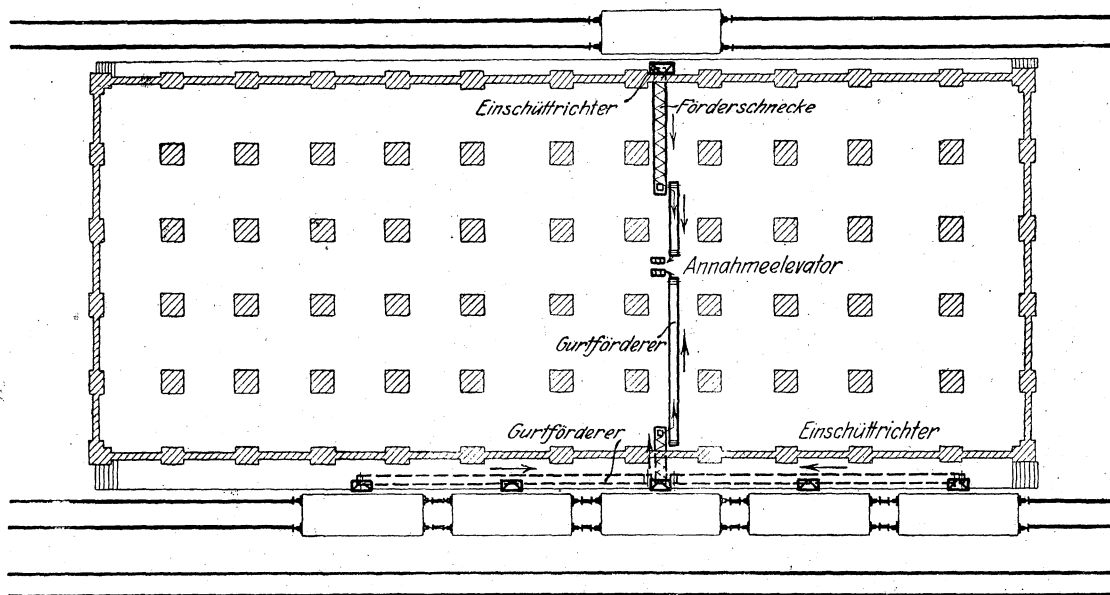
Grundriß des Lagerhauses in Regensburg.
